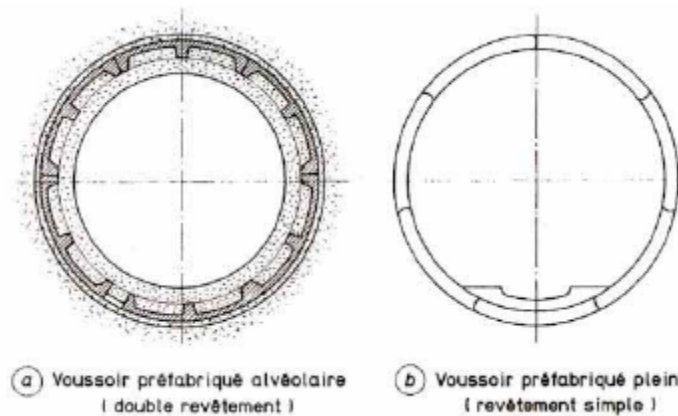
Voussoirs préfabriqués en béton armé.
